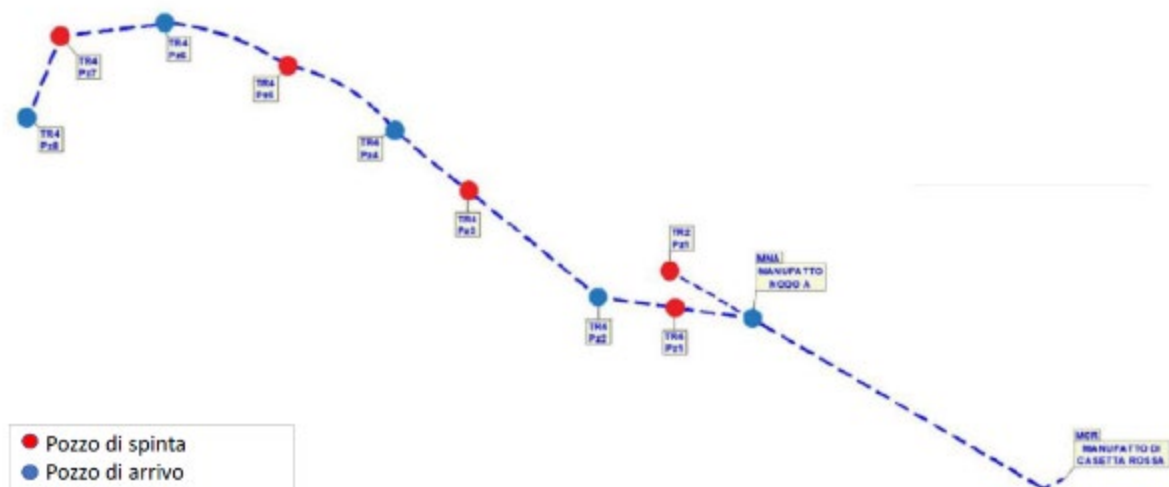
Ubicazione dei cantieri lungo il tracciato della 1a fase funzionale del nuovo acquedotto Marcio
